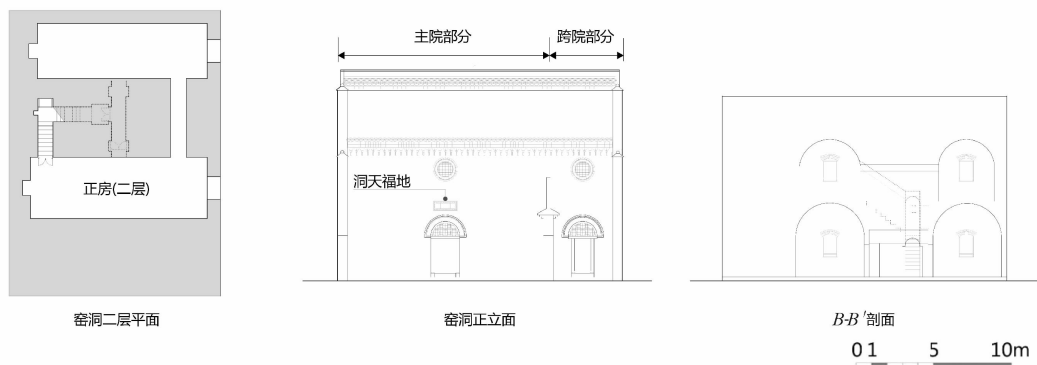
陈思礼故居窑洞的二层平面、正立面、B-B'剖面图
